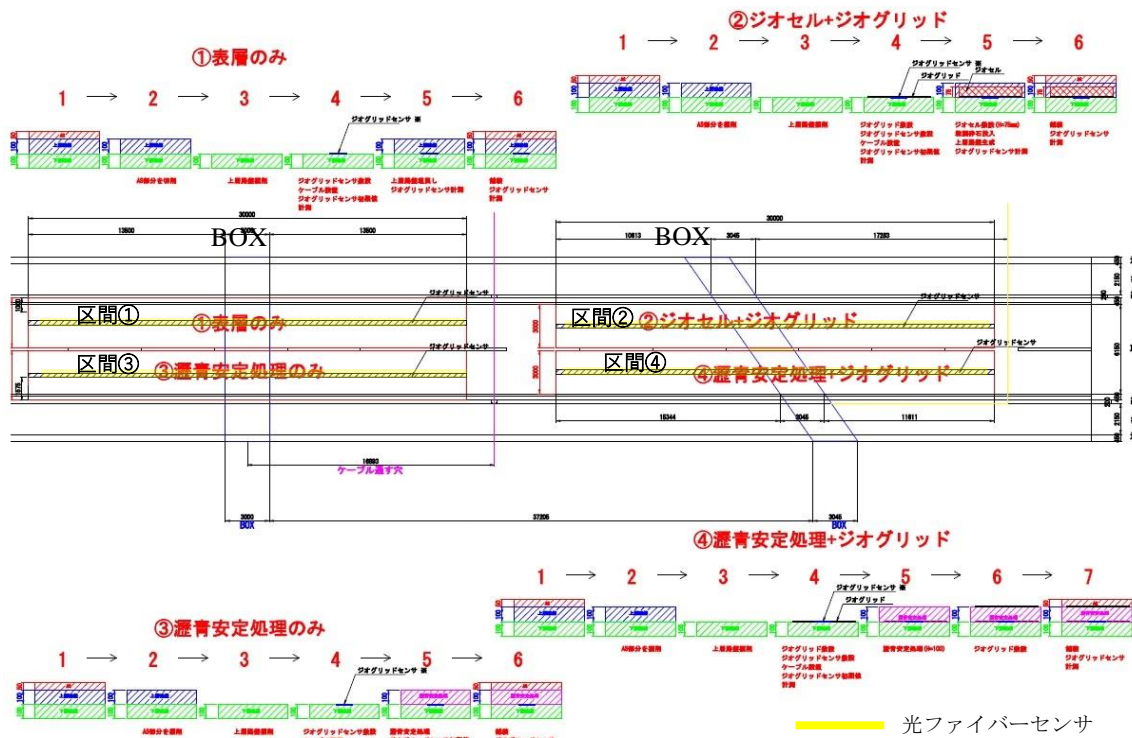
試験施工区間の平面図と光ファイバーセンサ敷設位置
